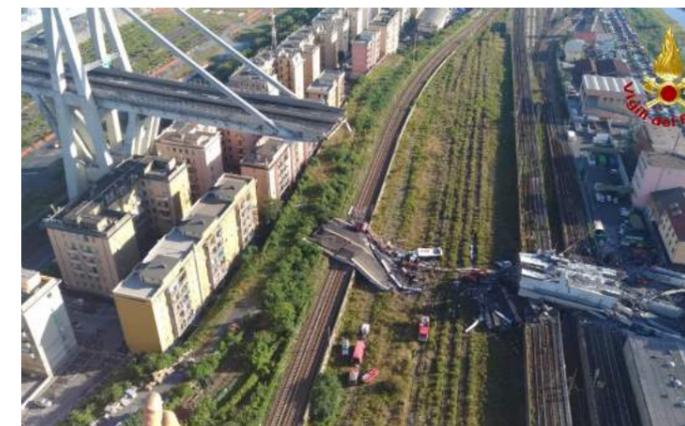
Pila 10 e macerie trave gerber e campata cappottata
